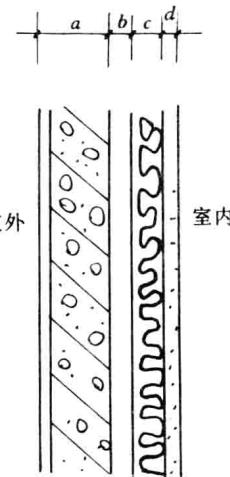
现浇钢筋混凝土内保温外墙示意图
